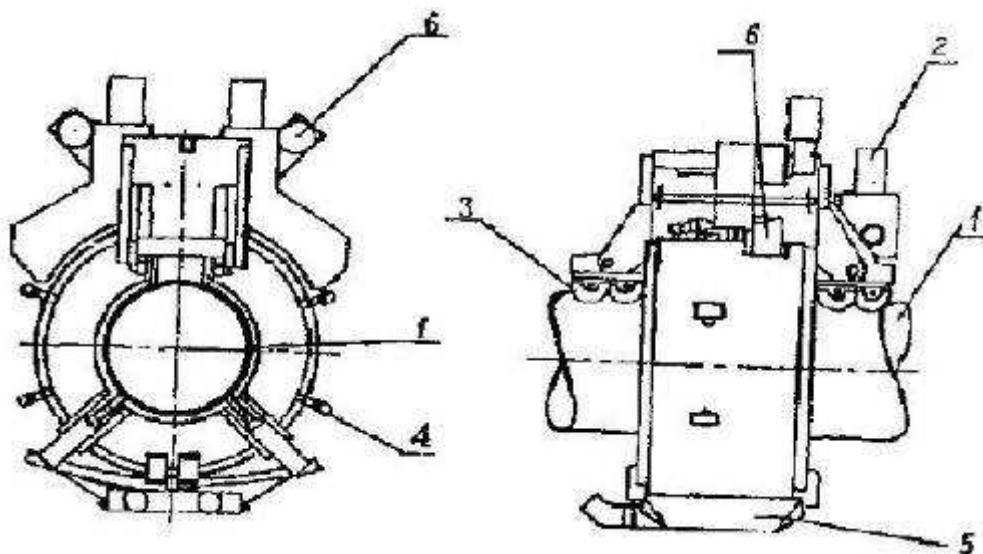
Схема пневматической машины для подготовки поверхности трубопровода дробеструйным и пескоструйным способами (а – вид спереди; б – вид сбоку): 1 – трубопровод; 2 – двигатель; 3 – катки; 4 – форсунка для песка (дроби); 5 – поддон для сборки песка (дроби); 6 – патрубки для отсасывания пыли
